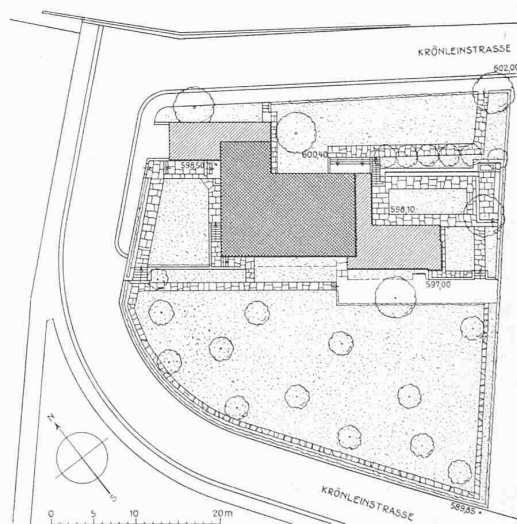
Lageplan des Hauses „Am Rank“. — Masstab 1 : 800.
